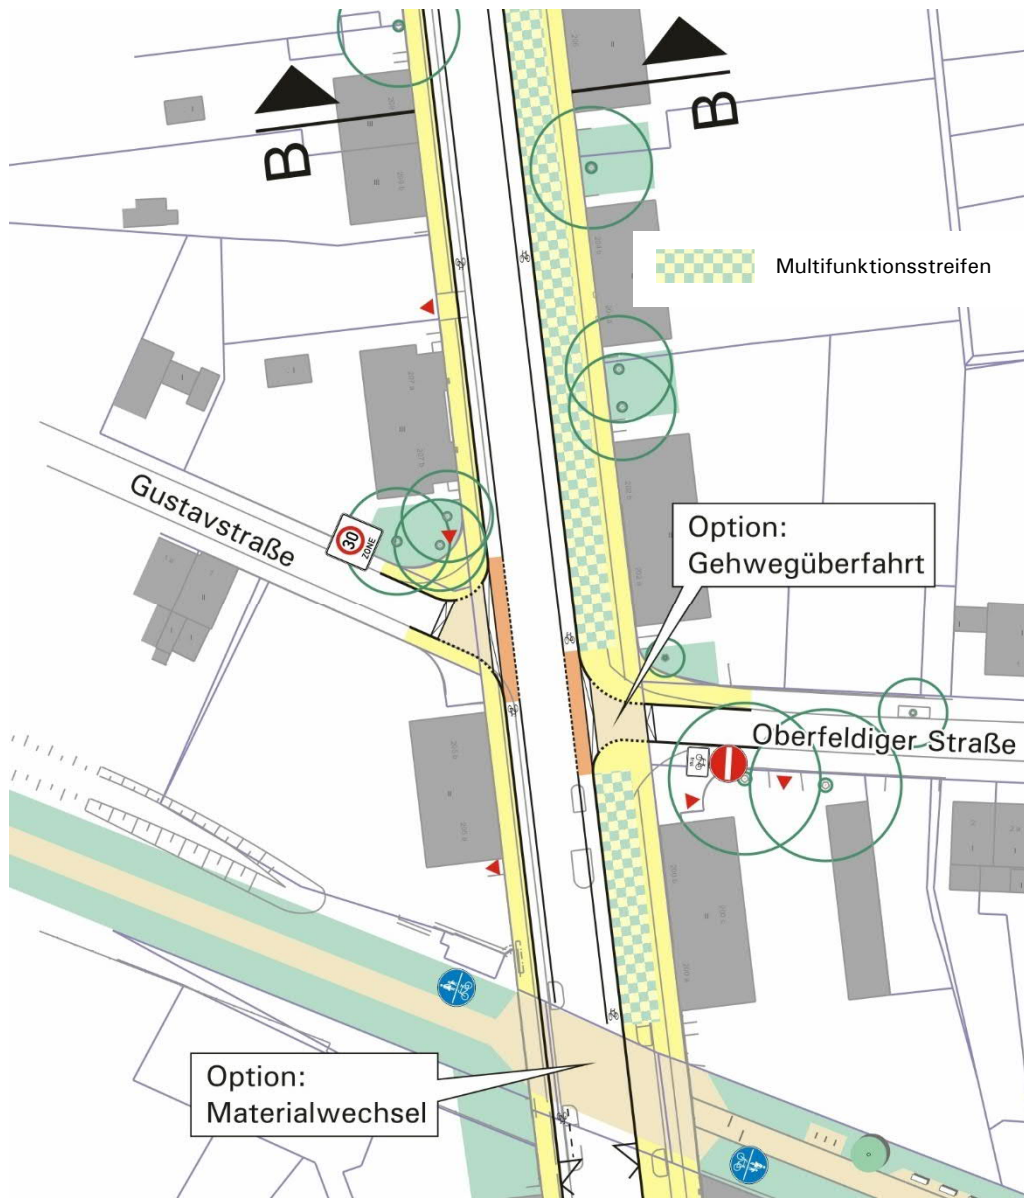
Lageplanausschnitt Gartenstadt – Variante 3 Grüne Achse
